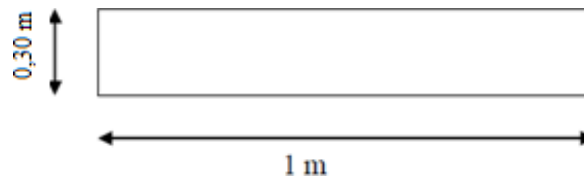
Section du calcul du ferrailage pour mur de soutènement.
